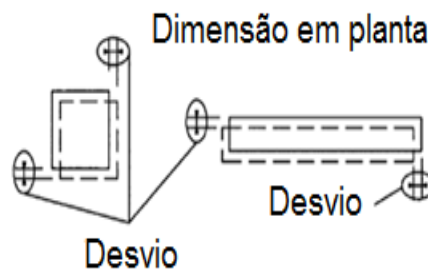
Posição em planta de vigas e lajes (adaptado da Fig. R4.2.1 [11]).
